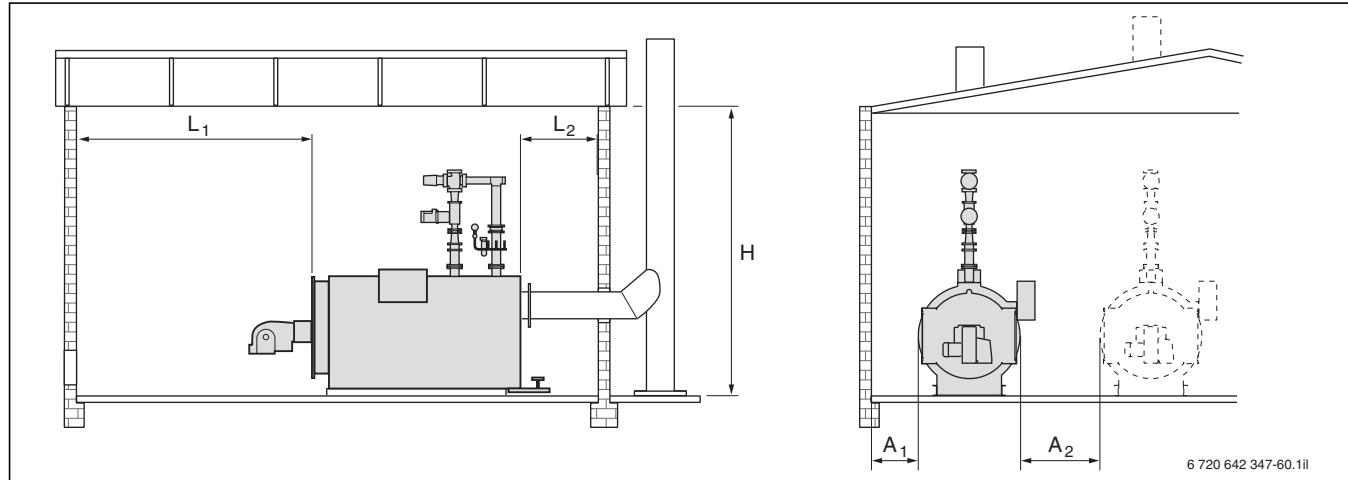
Dimensions du local d'installation chaudières UNIMAT UT-L
